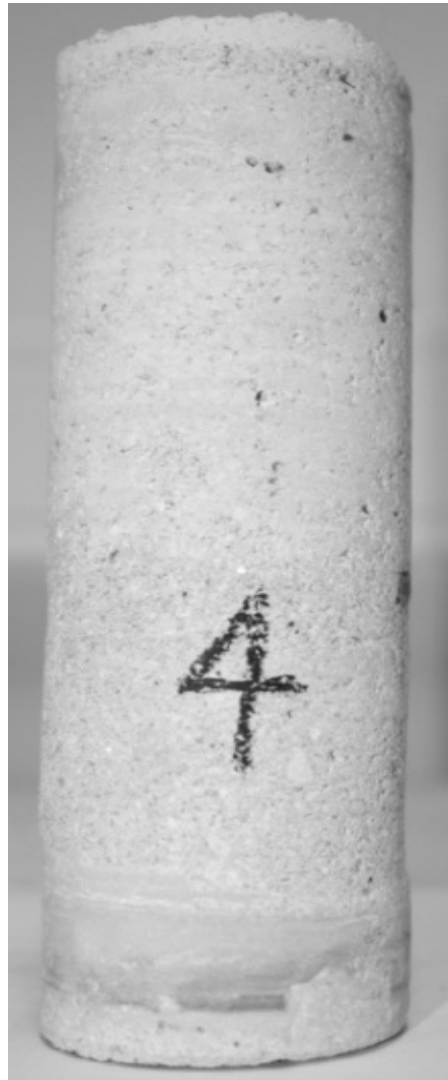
Échantillon en Pierre armée Pauchot constituant la paroi extérieure des murs de façade, prélevé en mai 2010 à Saint-Vincent.
